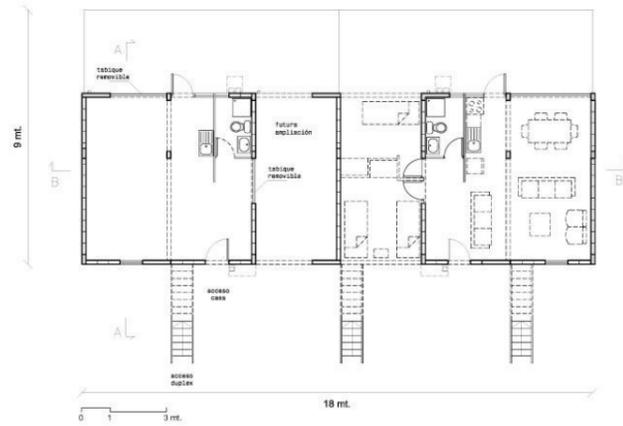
Propuesta final planta baja - www.elementalchile.cl
